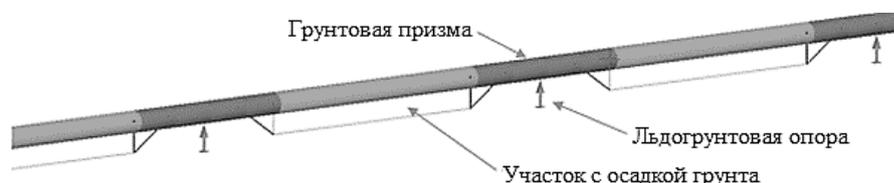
Схема моделирования участка подземной прокладки трубопровода с устройством намораживаемых грунтовых опор
